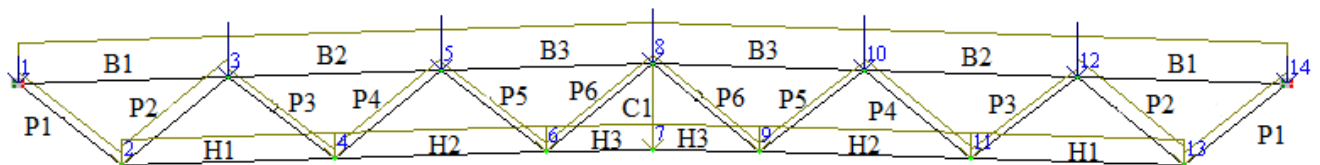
Розрахункова схема кроквяної ферми
